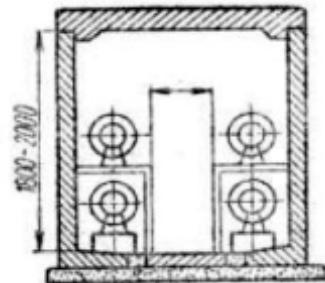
Прохідний канал із збірних залізобетонних плит і стінових блоків
